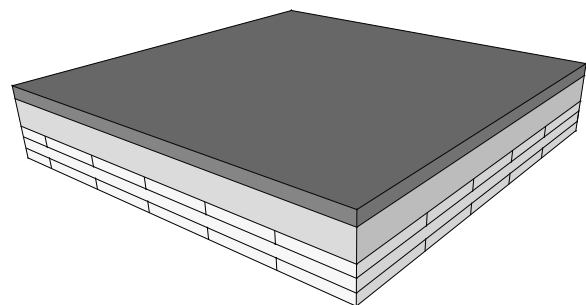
Konstruktionsschema Holz-Leichtbeton Verbunddecke
